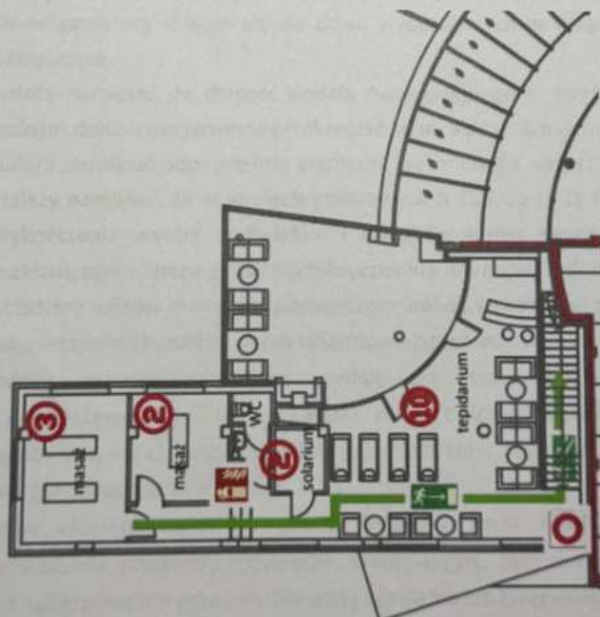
Rzut poziomy -1 – strefa pożarowa F
